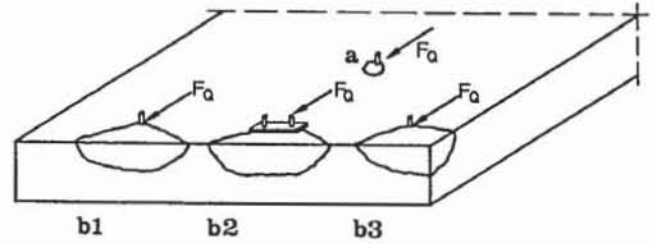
a und b. Versagensarten bei Querbeanspruchung; a Stahlbruch; b Betonbruch (entnommen aus [2])
